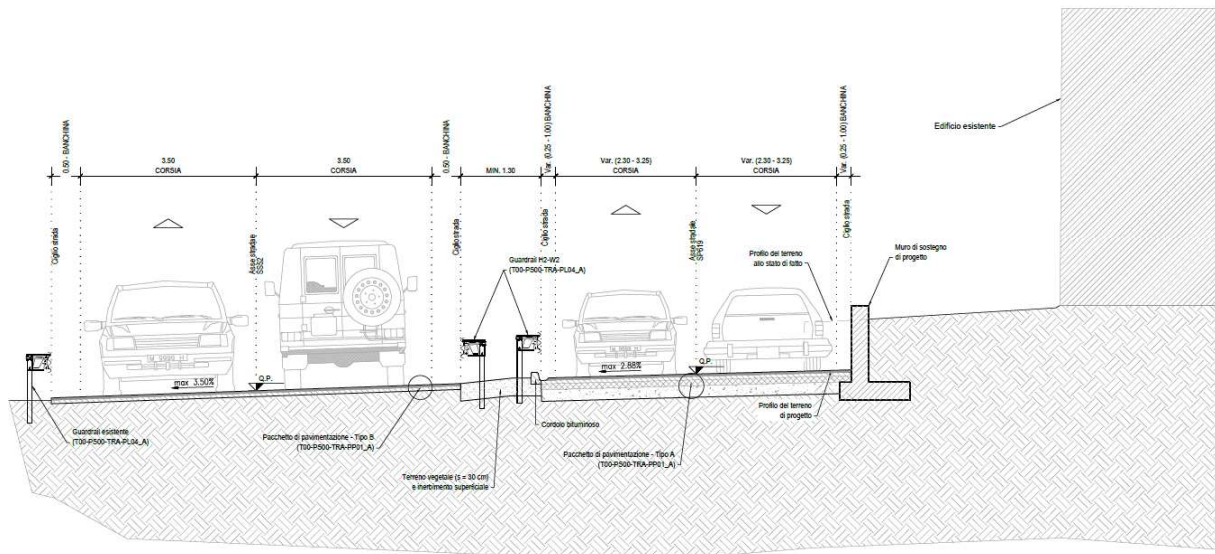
Sezione tipo SS52/SP619 con muro di sostegno su SP619
